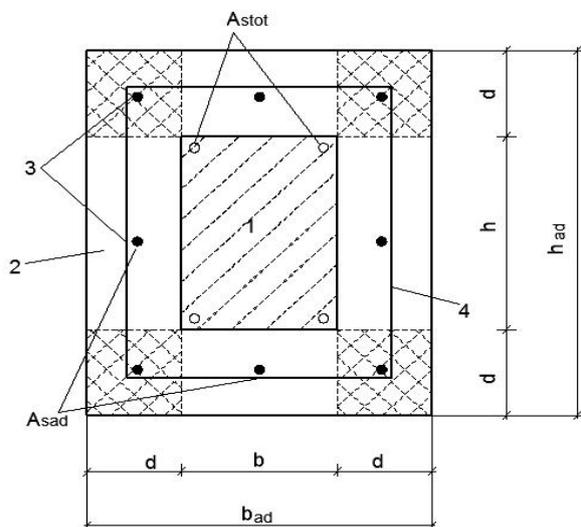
Расчетная схема усиления прямоугольной колонны железобетонной обоймой:
